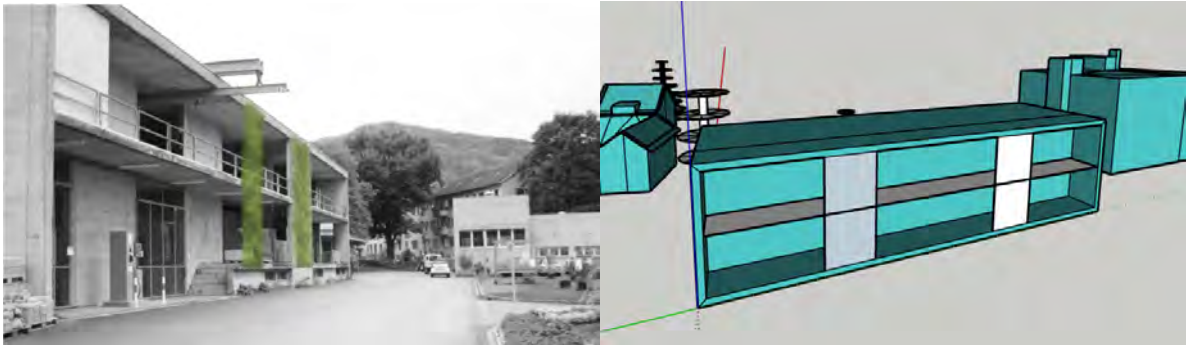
à gauche, une photo du bâtiment étudié avec ses façades végétales, à droite le bâtiment modélisé sur SketchUp avec en gris la façade rideau et en blanc le mur vivant.
